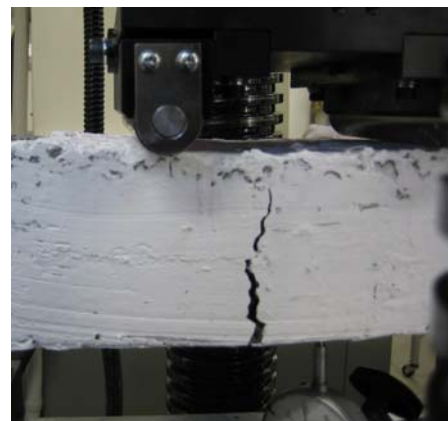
ひび割れ状況 (試験体 : V15B363, P=4.6kN)
